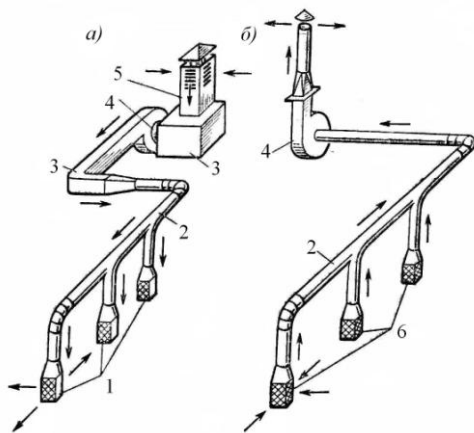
Схемы механических общеобменных вентиляционных установок:
